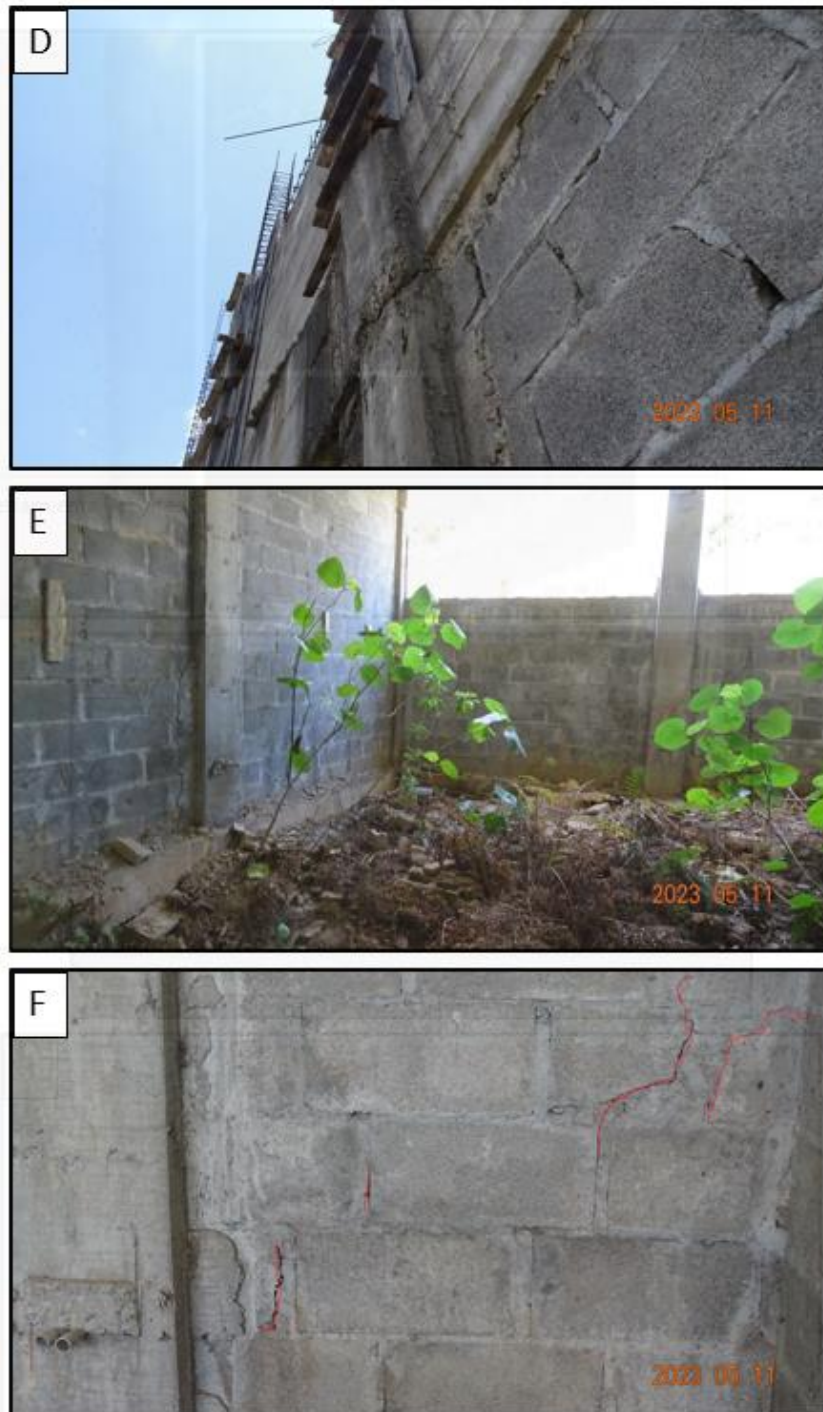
Deficiencia constructiva de (D) Columna falseada, (E) Escombros en zona de futura colocación del contrapiso, (F) Agrietamiento en bloques de mampostería, del edificio de aulas no.4 del CTP José María Zeledón Brenes
